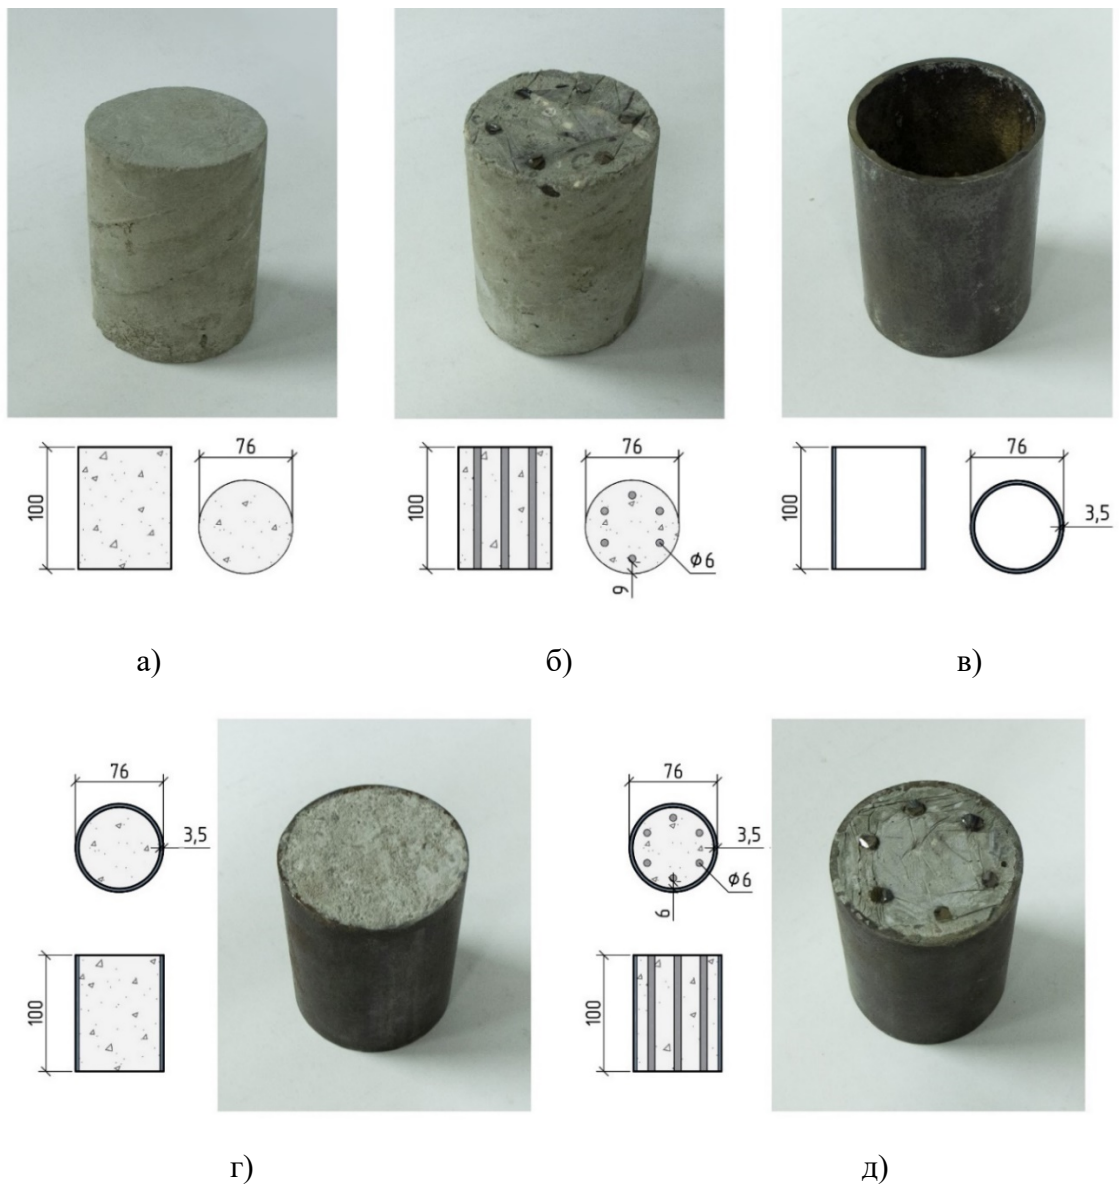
Подготовленные образцы длиной 100 мм: а) бетон; б) железобетон; в) стальная труба; г) трубобетон; д) армированный трубобетон.
